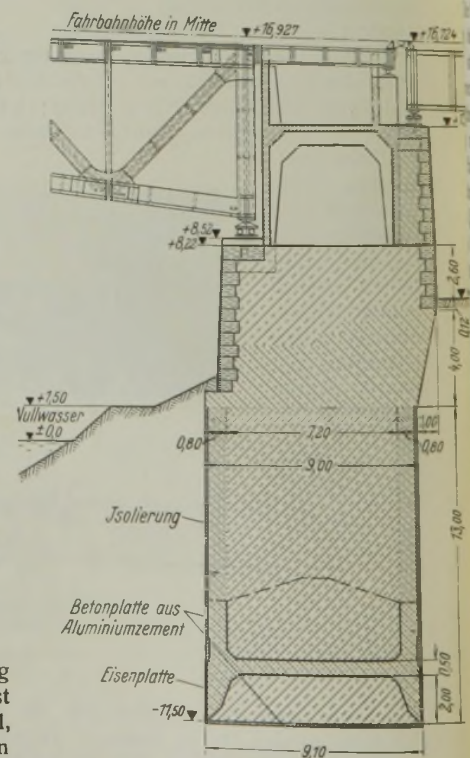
Querschnitt durch den Pfeiler am rechten Ufer.
